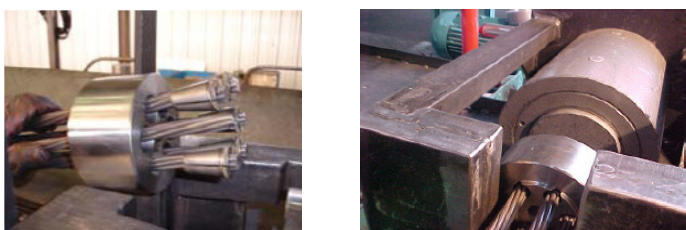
Pré cunhagem dos cordões à cabeça de ancoragem e dispositivo hidráulico
